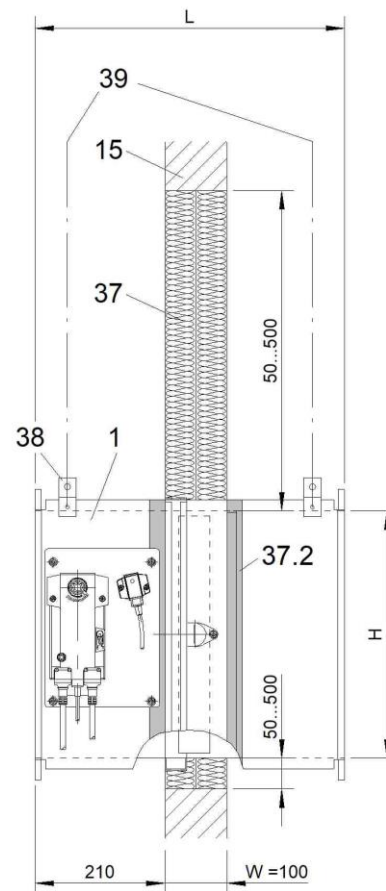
montaggio in parete massiccia (spessore parete = 100 mm)
